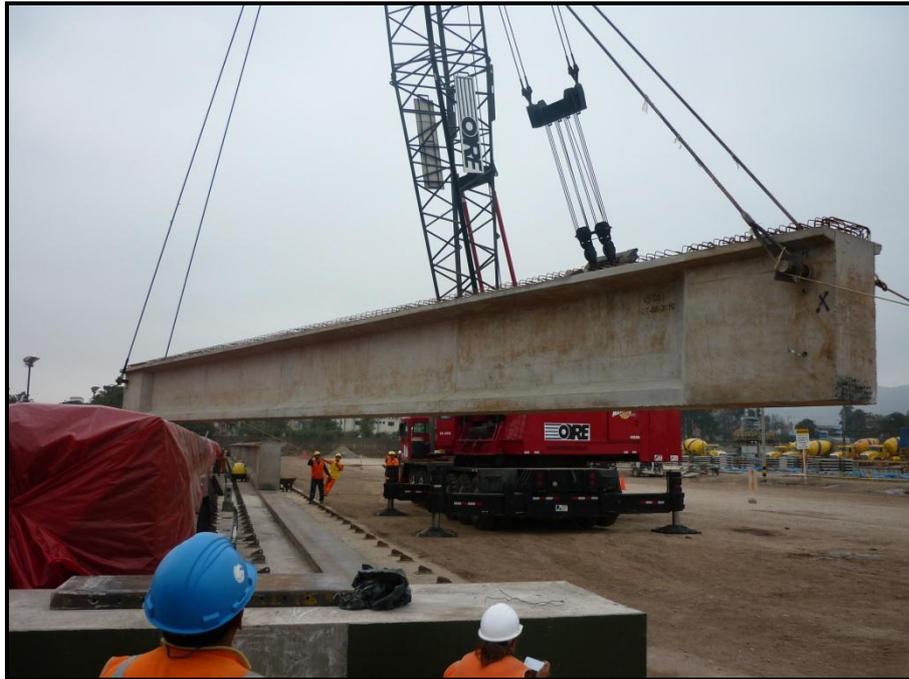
El desafío en la fabricación de estas vigas atípicas en un espacio reducido y con un área de Stock casi nulo, conllevó al continuo despacho de vigas hacia el frente de montaje
